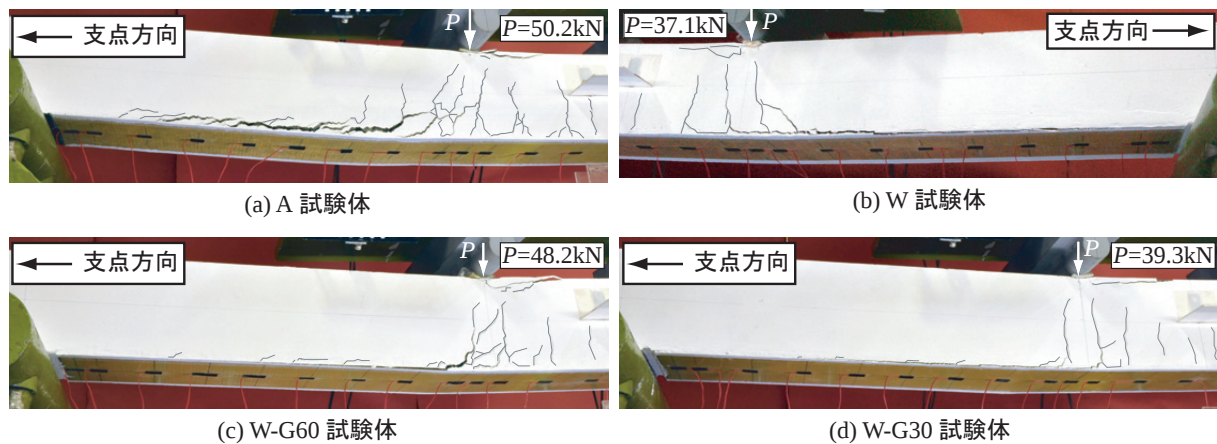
各試験体の終局直前におけるひび割れおよび剥離性状
